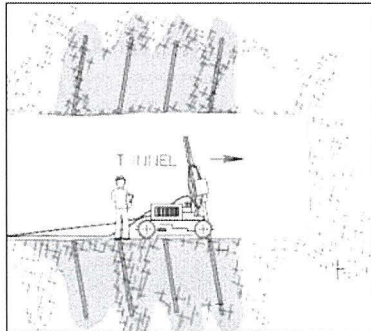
Post-consolidation grouting behind of tunneling excavation ^{2.28)}
